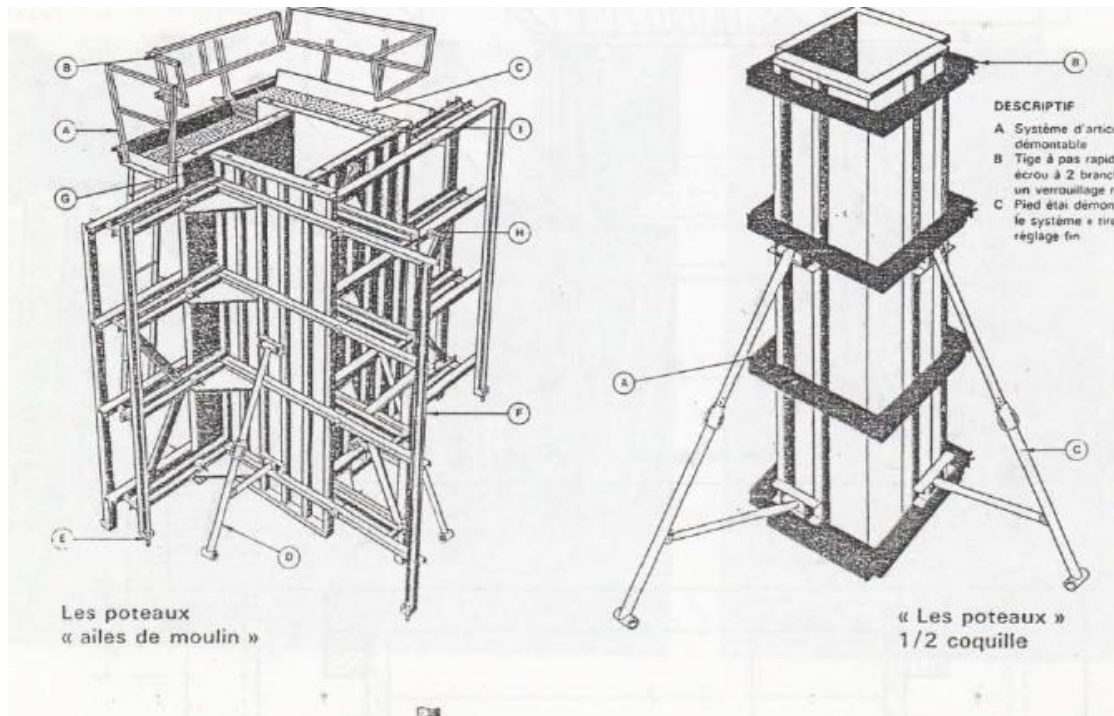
Coffrage en demi-coquille et en aile de moulin d'un poteau carré
